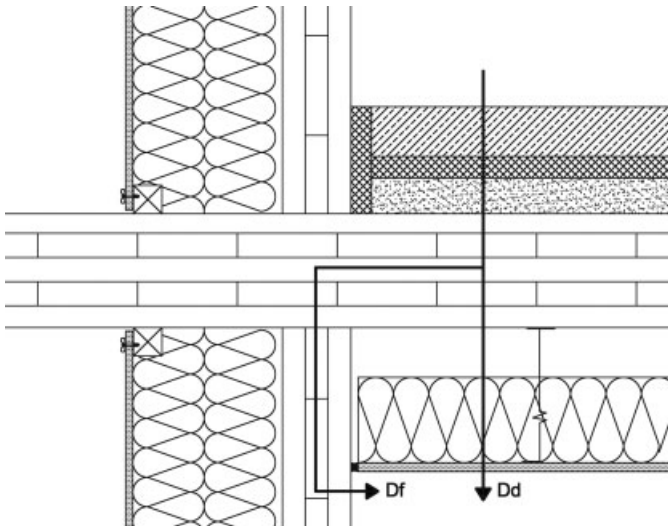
Aufbau der Stoßstelle Wand-Decke
